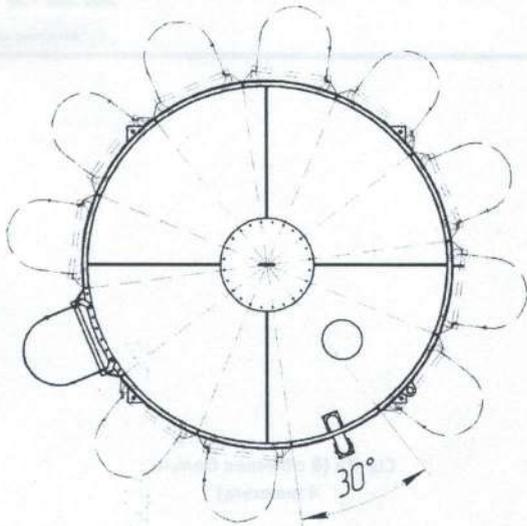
Схема возможного расположения лестницы (вид сверху)
